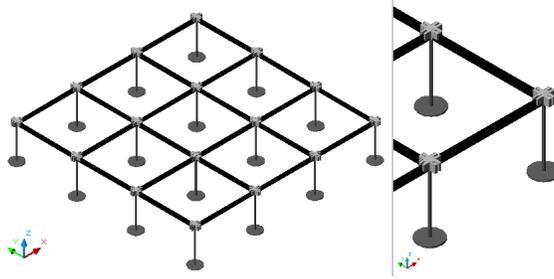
Soportes y estructuras metálicas<sup>69</sup>
